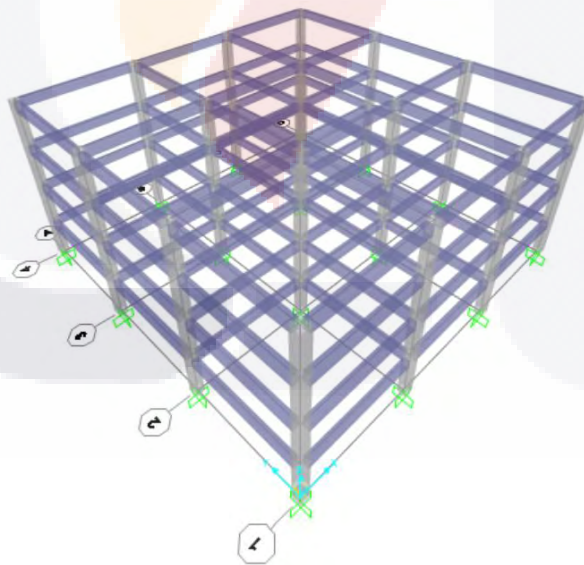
Vista isométrica del modelo estructural representado por secciones. Las columnas se muestran en color gris y las trabes en color violeta, con soportes empotrados asignados a todas las columnas.
